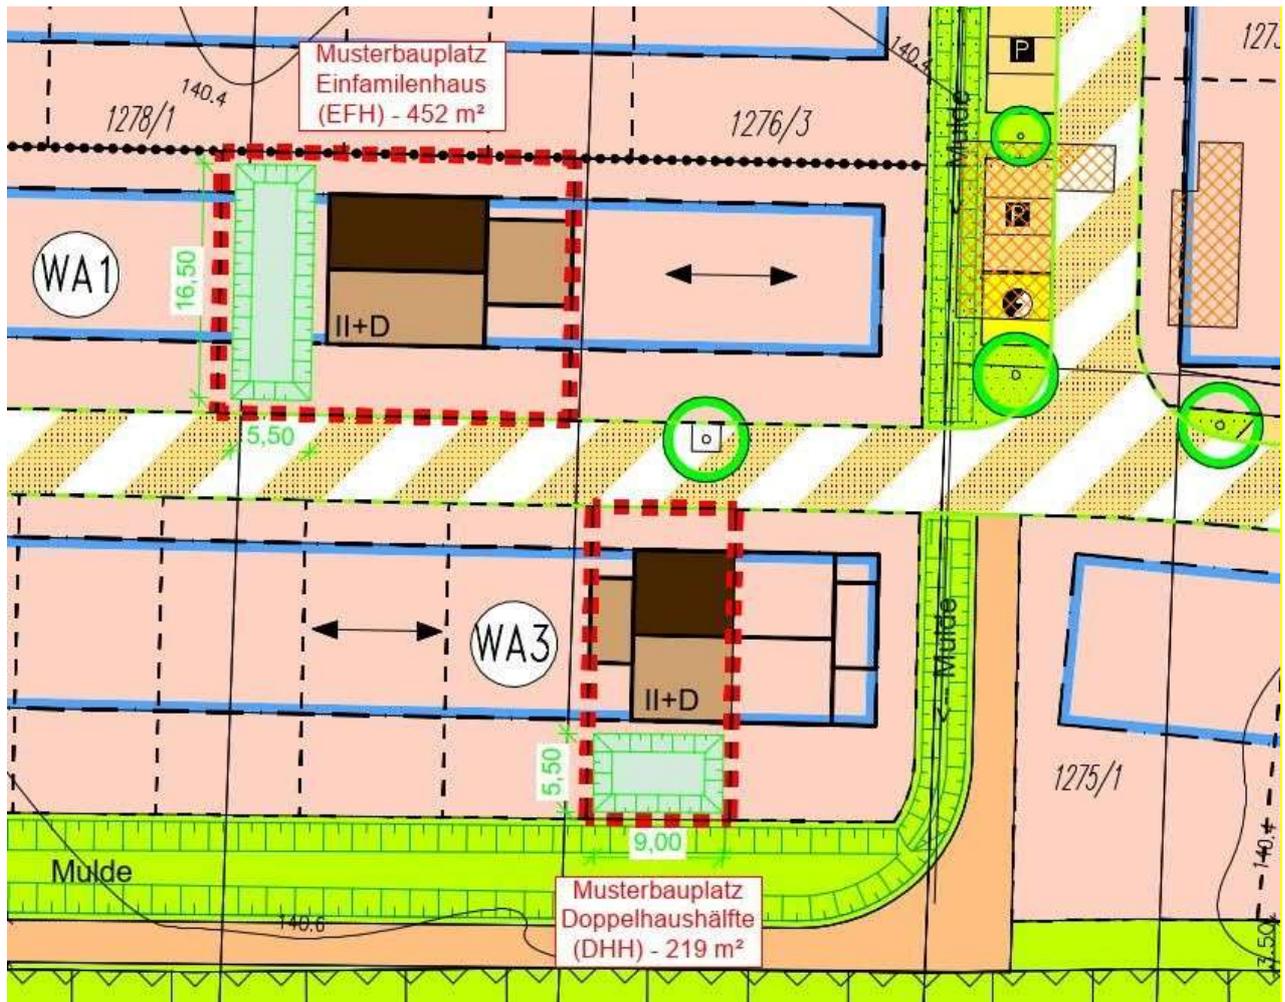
Lageplanausschnitt B-Plan mit Musterbauplätzen
